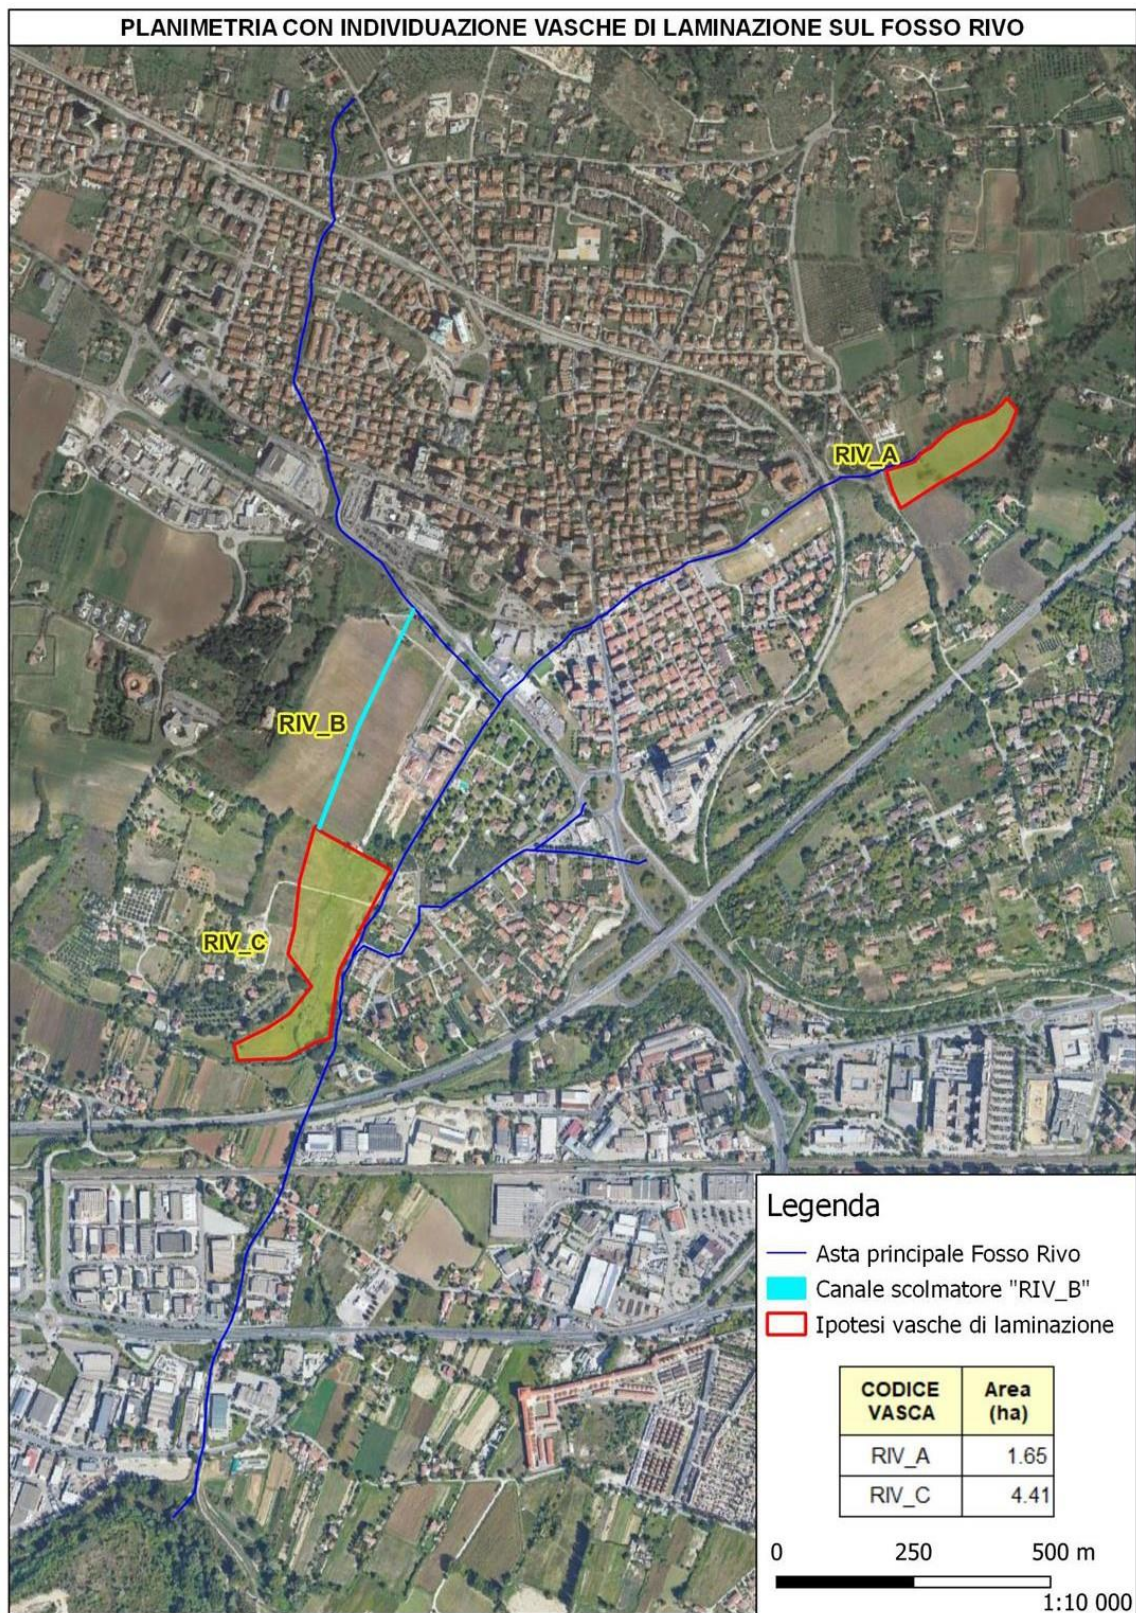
Planimetria con ubicazione delle vasche di laminazione lungo Fosso Rivo
